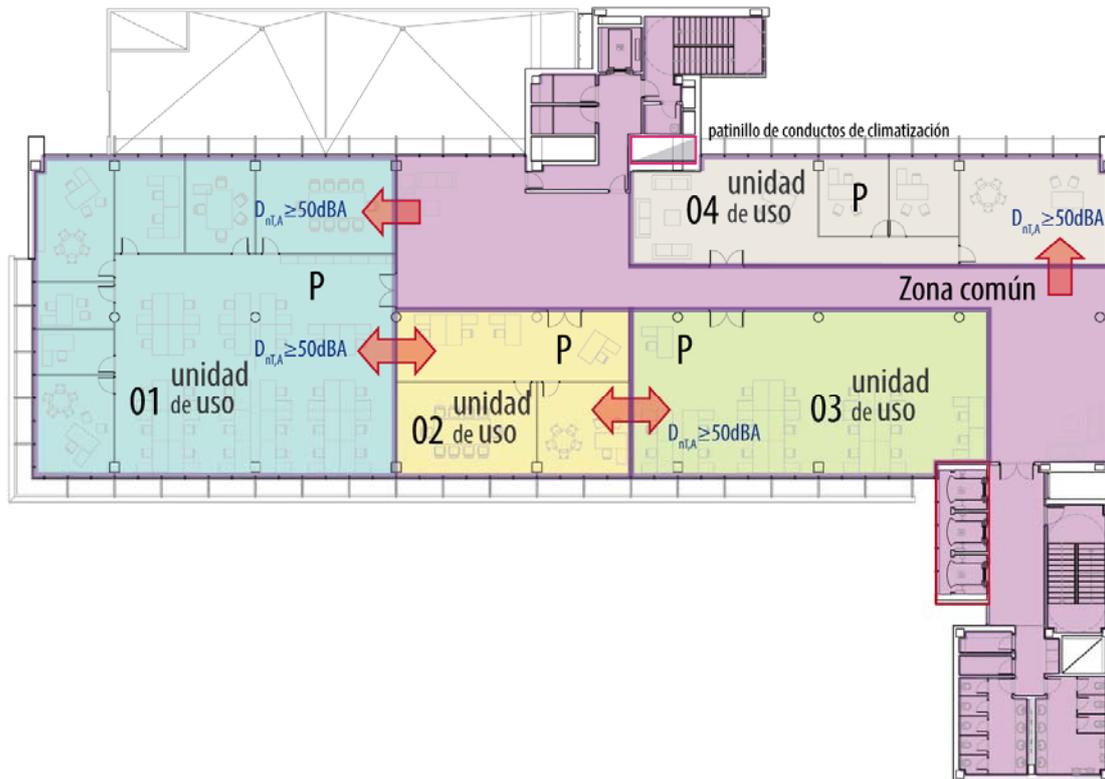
Planta tipo del edificio y valores de aislamiento acústico a ruido aéreo exigidos
